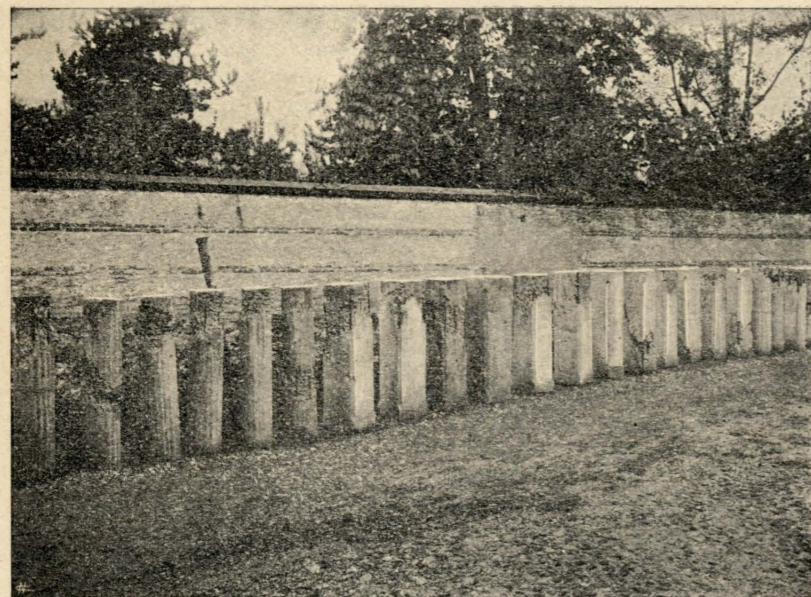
Veduta prospettica di colonnine e pilastri sottoposti all'esperimento.
